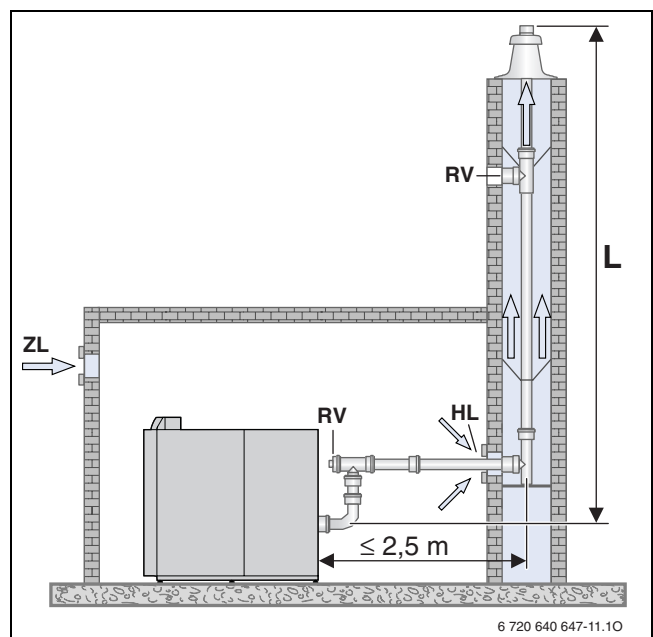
Esempio per la disposizione dell'apertura d'ispezione con una tubazione dei gas combusto orizzontale con deviazione nel locale di posa
